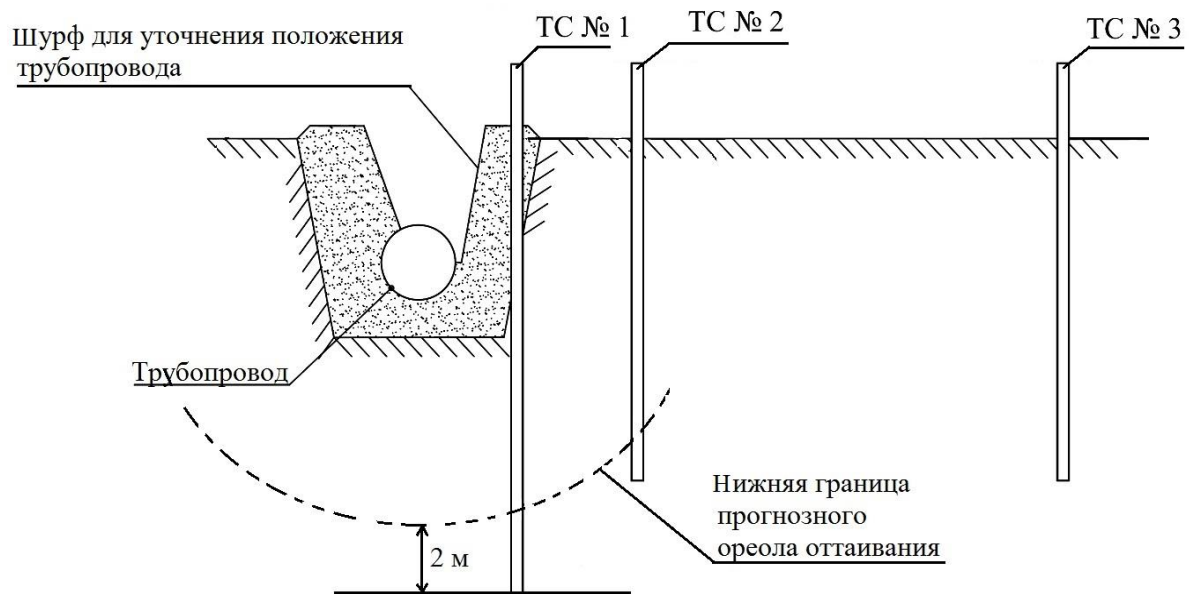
Схема типового размещения ТС для нефтепровода подземной прокладки
